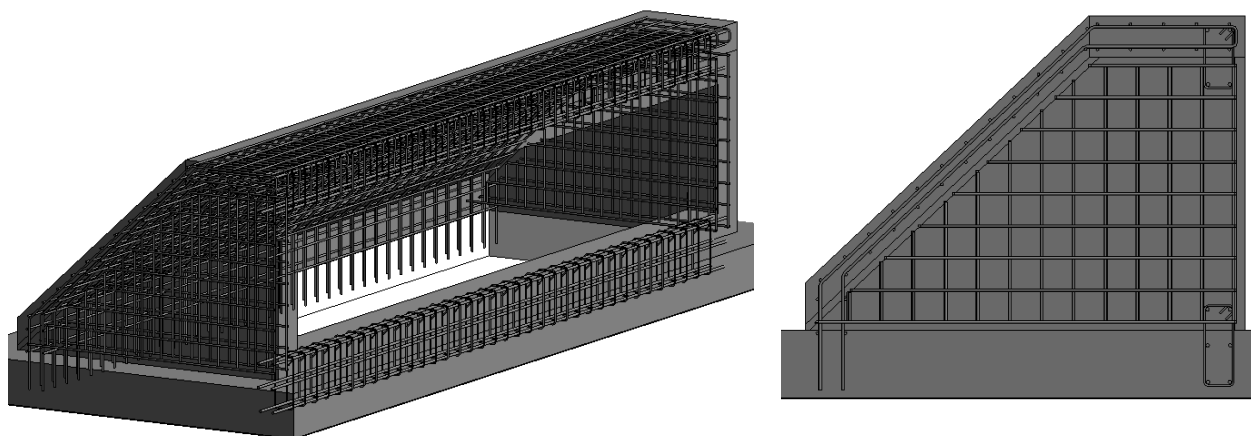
Modelos 3D de armaduras – Lajes inclinadas do centro de conferências
